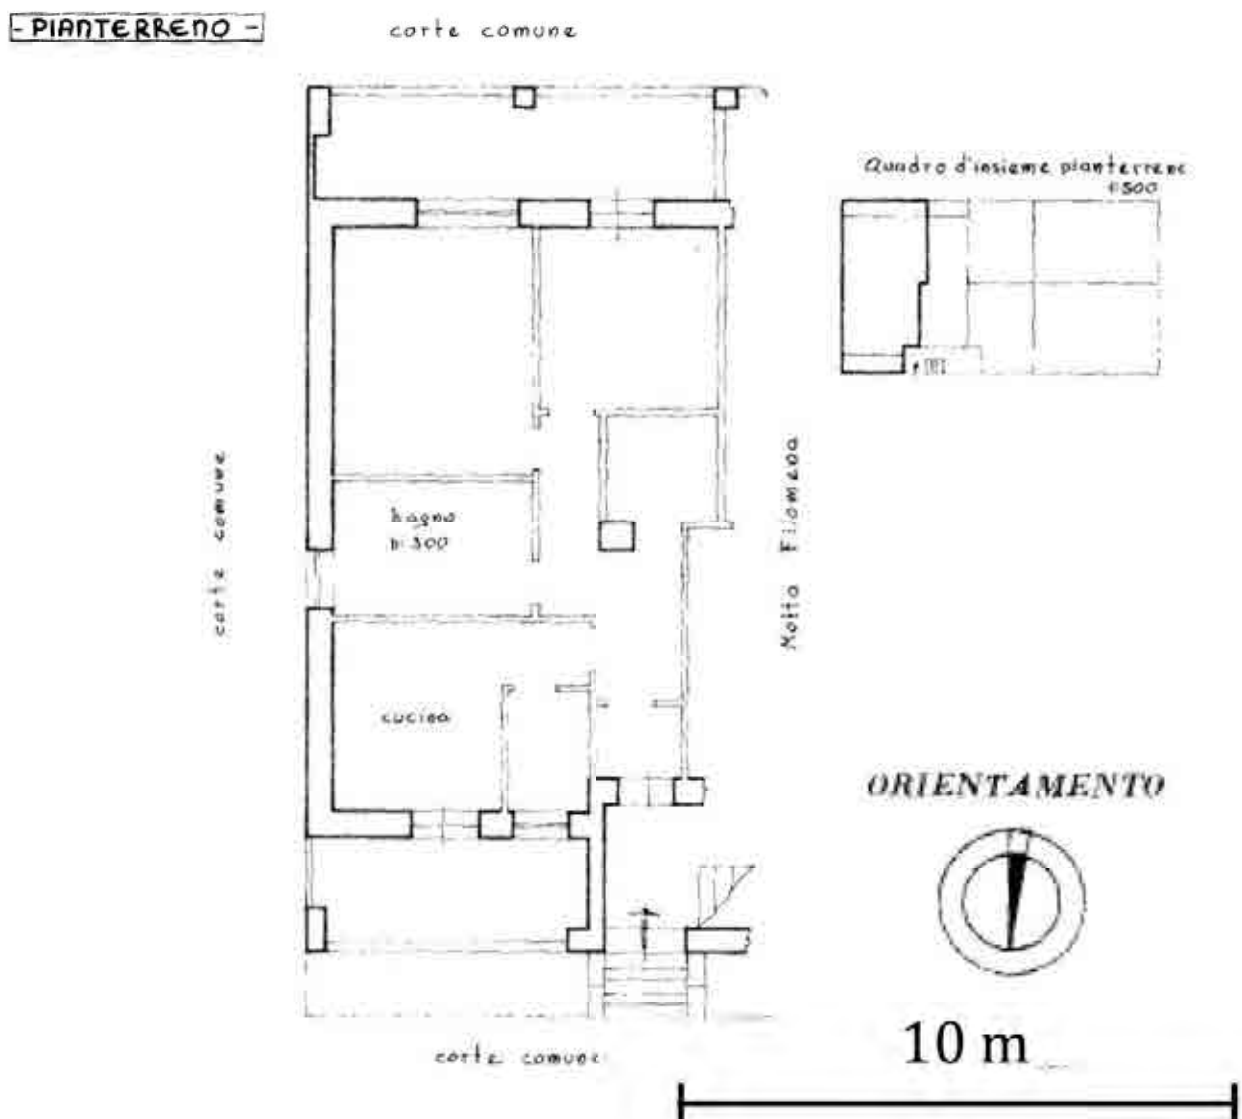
Estratto Planimetria Catastale - Appartamento NCEU Foglio ■ part. ■ sub ■ Piano Terra
